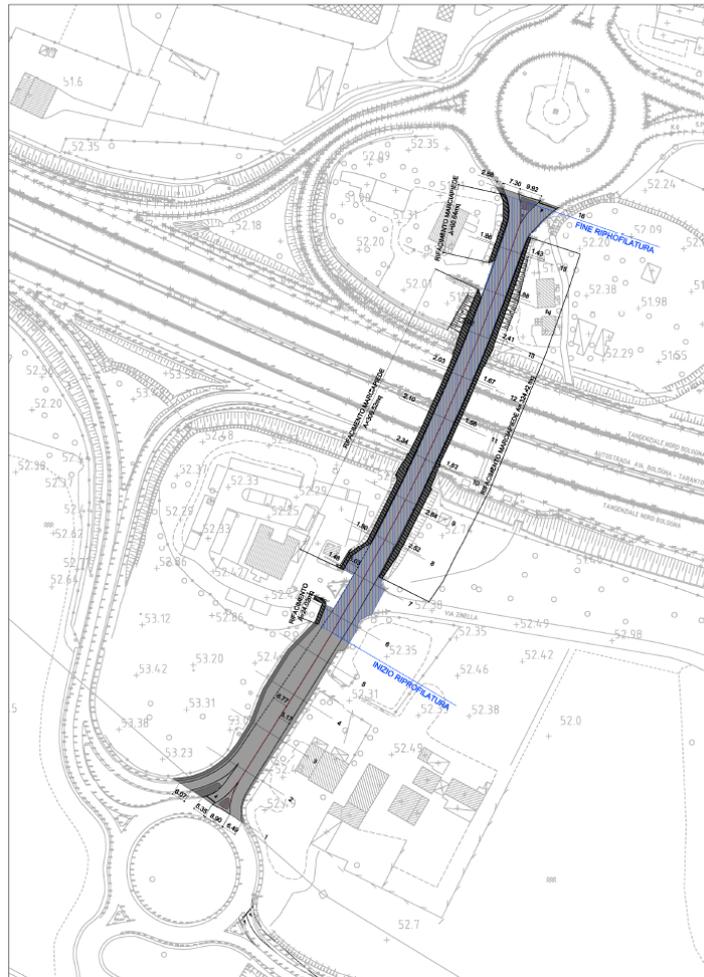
stralcio planimetrico intervento di riqualifica di via Caselle
